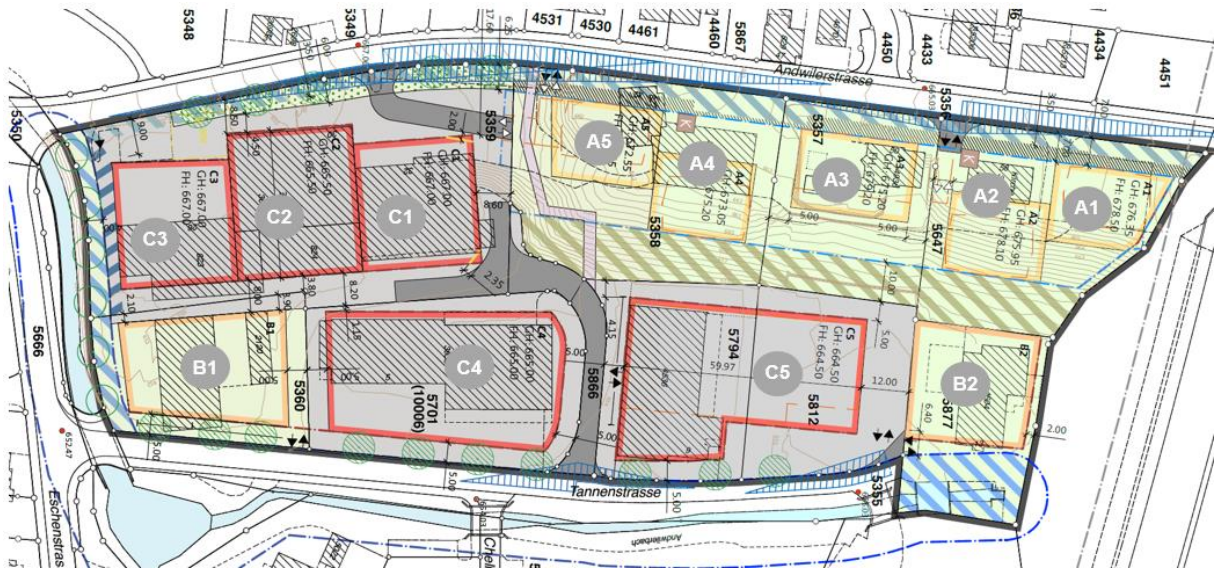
SNP Andwilerstrasse – Tannenstrasse, Planungsperimeter
